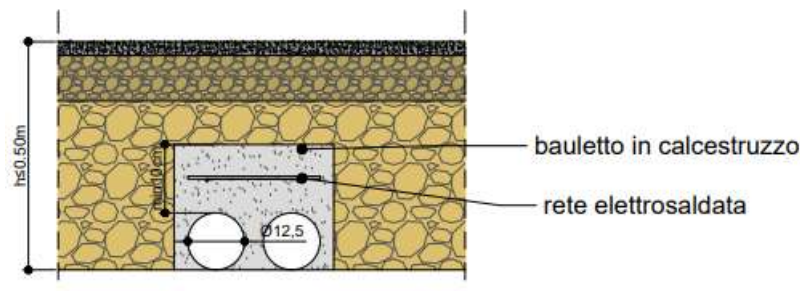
bauletto in cls di protezione dei cavi nel tratto in corrispondenza della galleria ferroviaria
